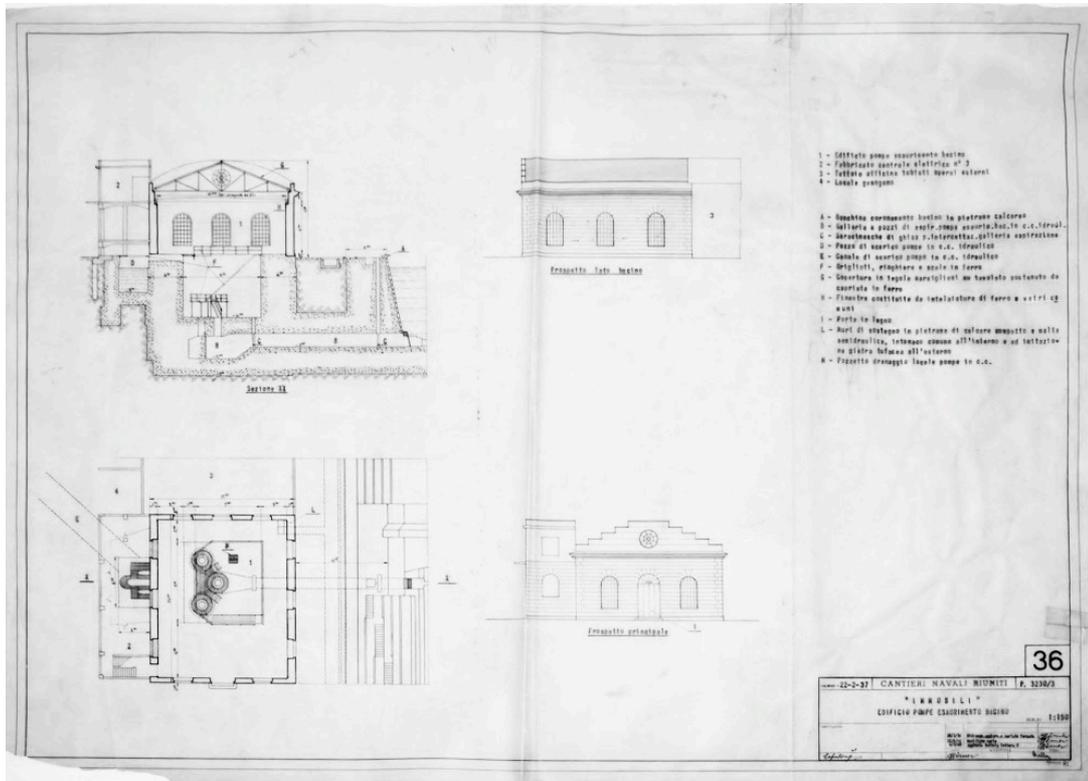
Tavola con elaborati in pianta, sezione e prospetto del locale pompe di esaurimento del bacino in muratura
